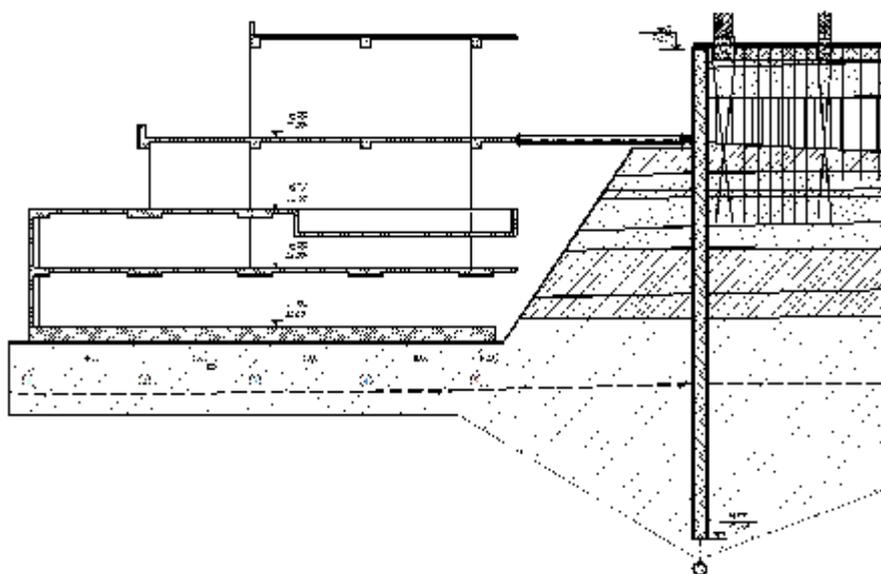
Установка первого яруса распорной системы с опиранием на монолитный каркас, разрез грунтовой бермы
